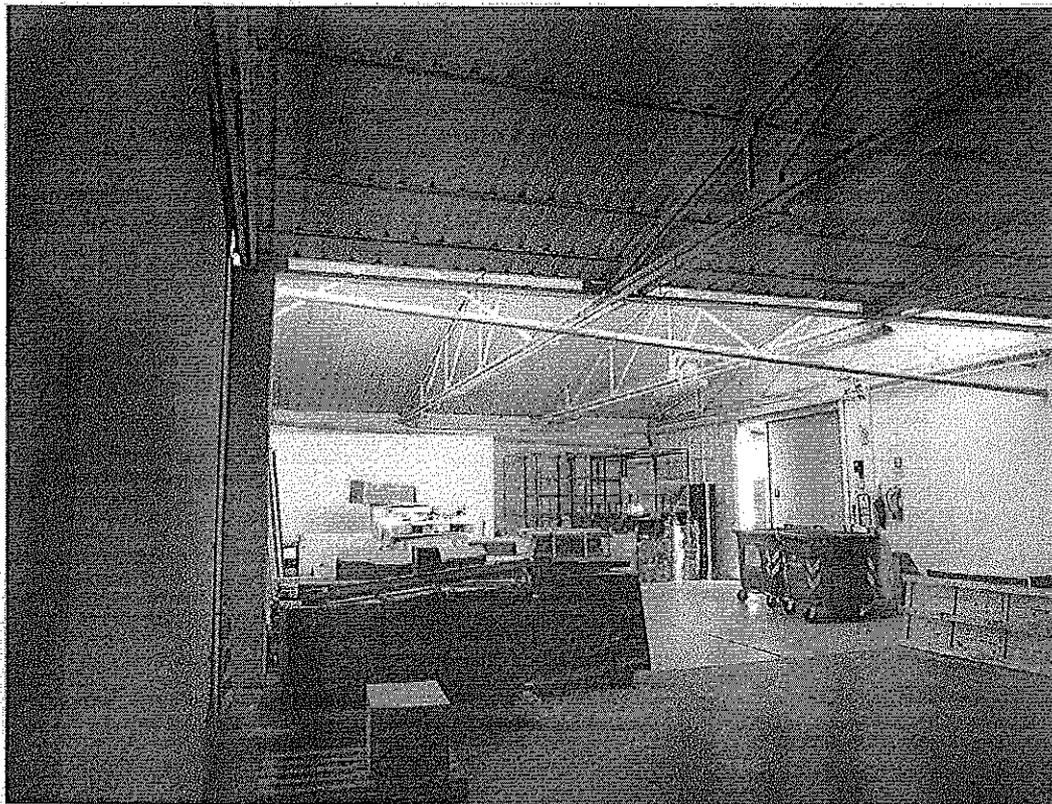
Corpo fabbrica ne fronte Ovest – vista interna.
